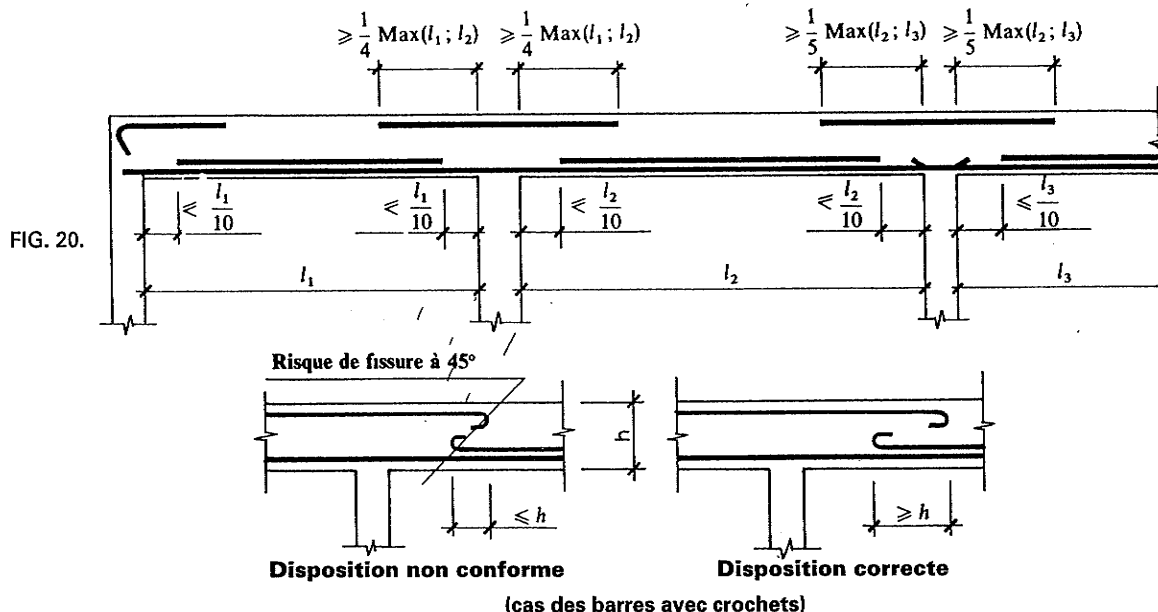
Détermination forfaitaire de la longueur des chapeaux et arrêts des barres inférieures.
